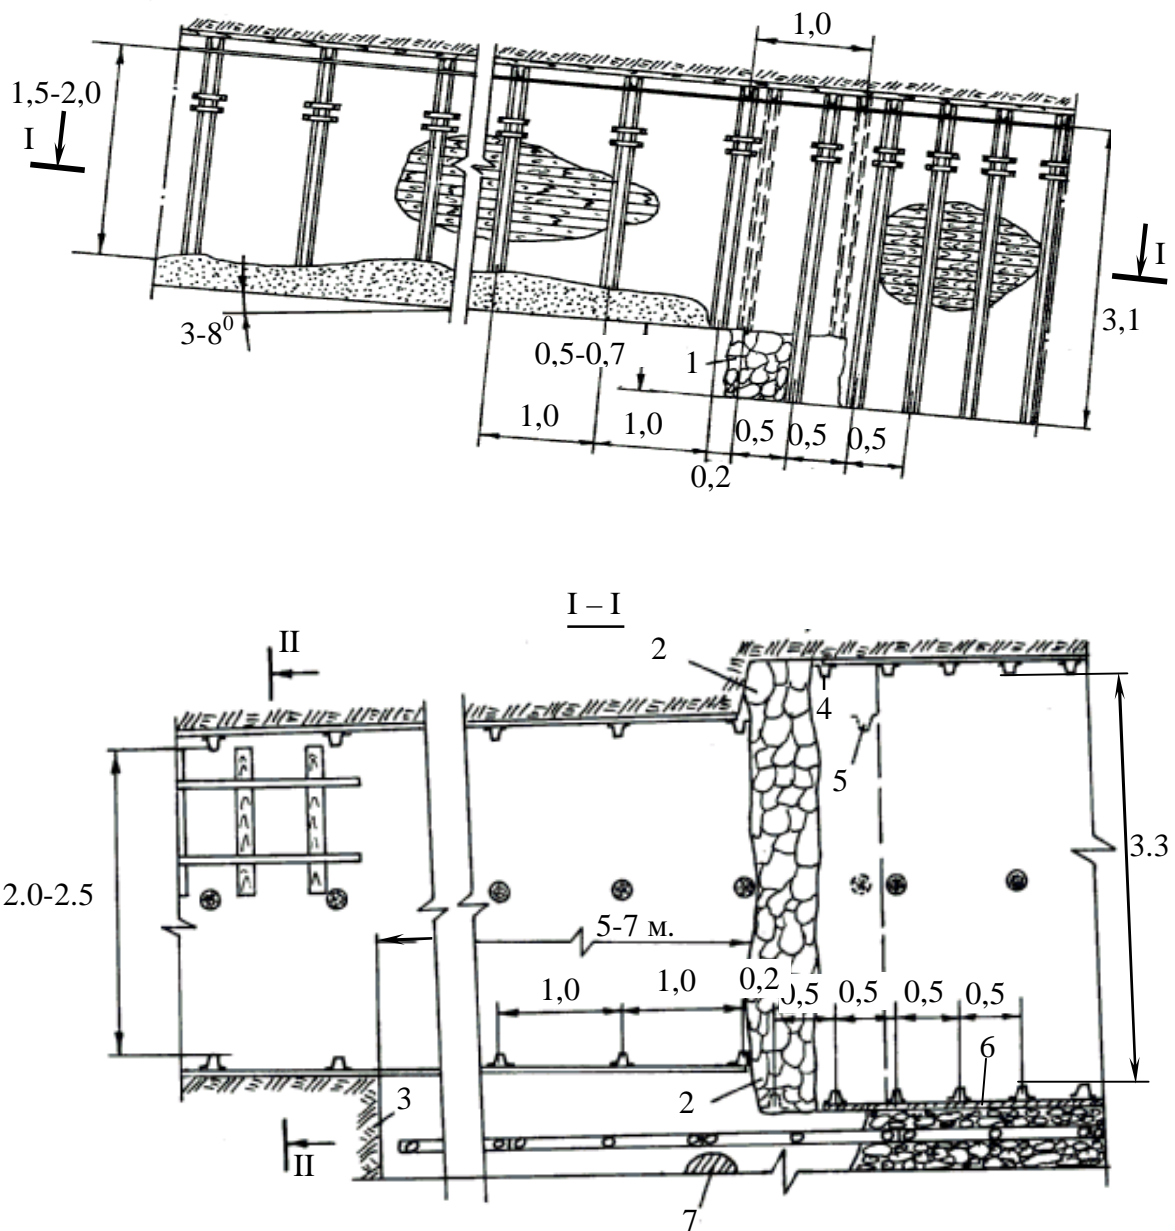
Схема розташування забою перекріплення перед (а) й позад (б) лави під час виймання полого нахилоного пласта по простяганню: 1 і 2 – лінії забоїв відповідно очисного й перекріплення; 3 – ніша; 4 – породна смуга; 5 – органне кріплення; 6 і 7 – скрепери відповідно поперечної й подовжньої дії
